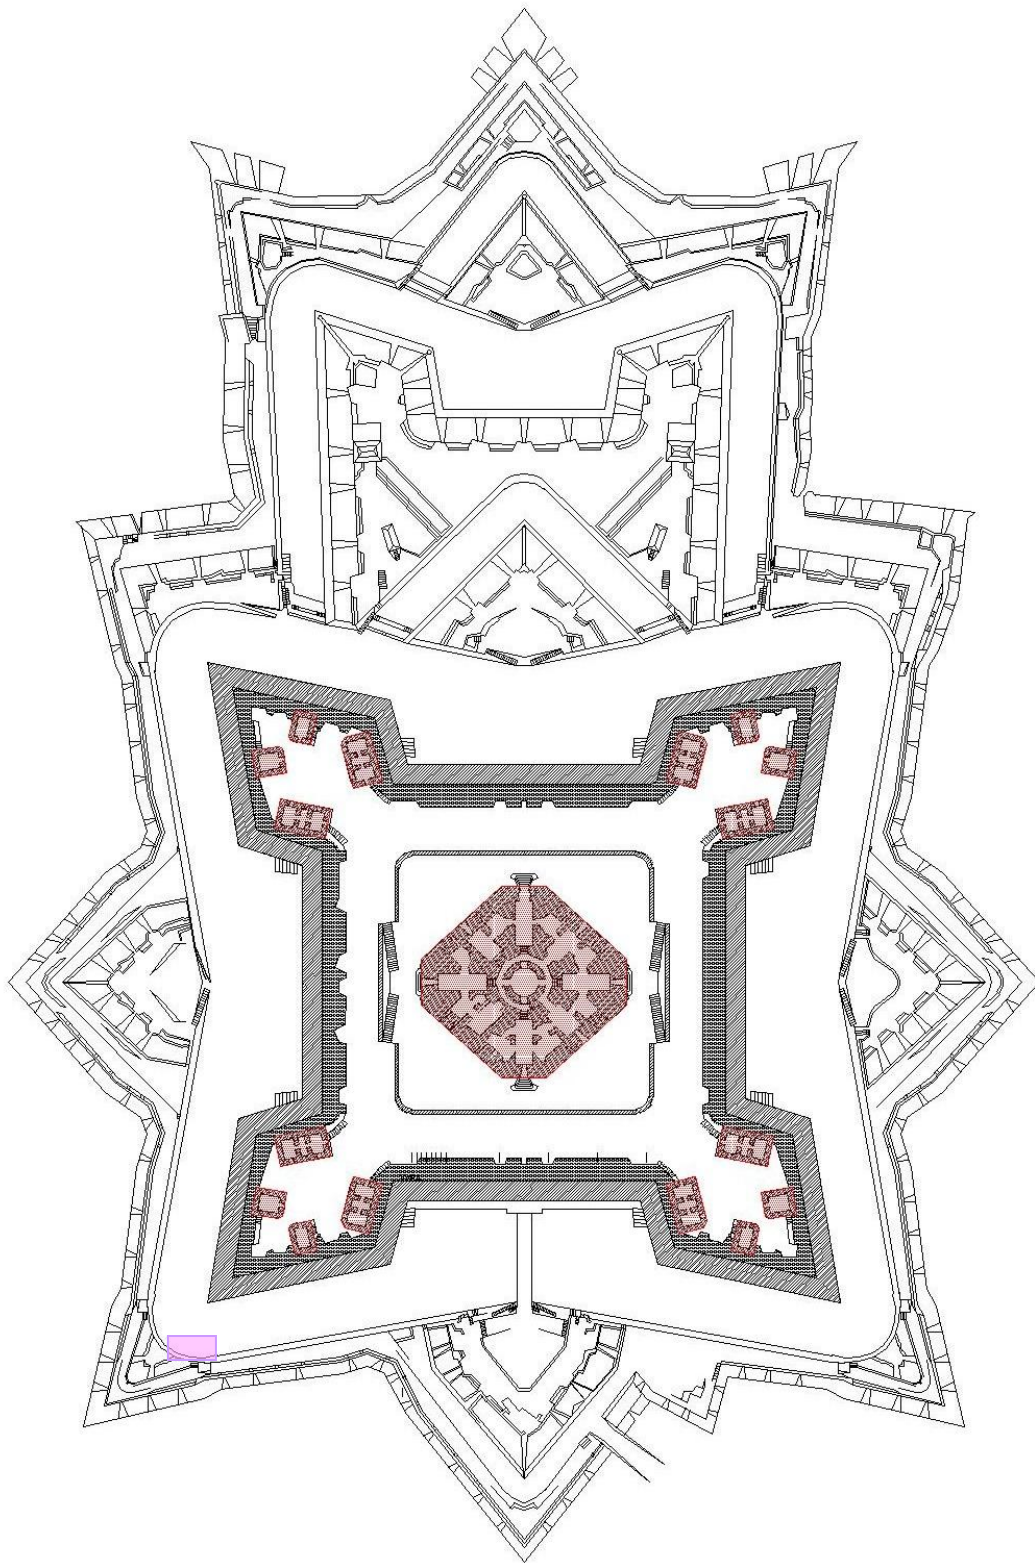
Indicação em planta das zonas de implantação (sombreado rosa) do espaço dedicado a Pousada, dentro do Reduto Central (piso 2)
